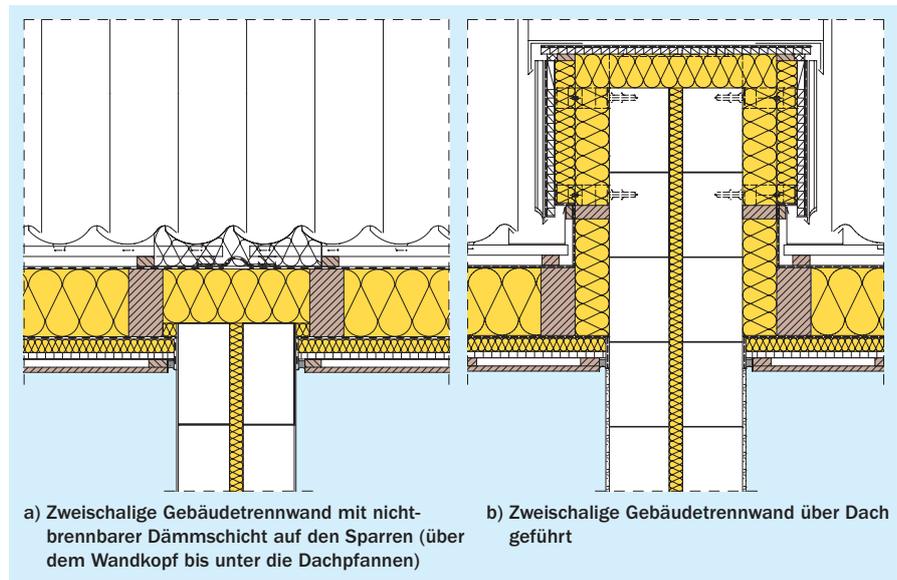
Gebäudeabschlusswand aus KS-Mauerwerk im Dachbereich
